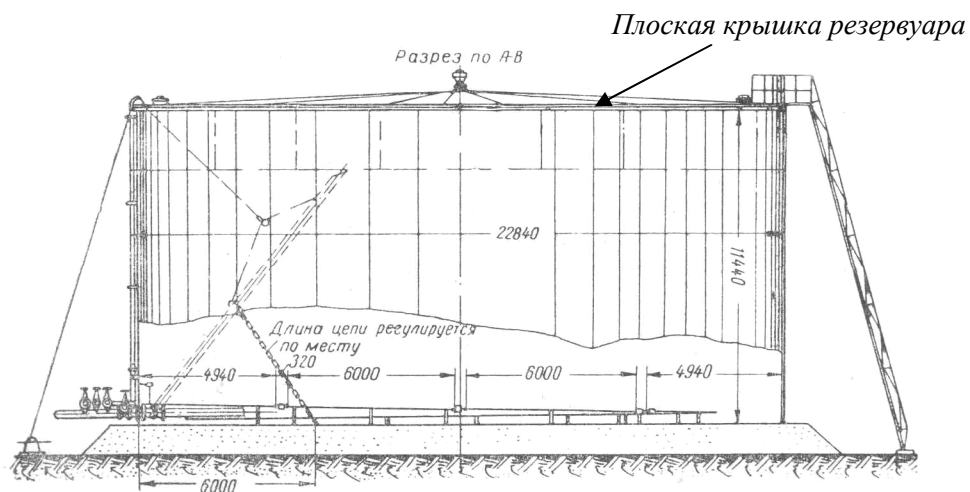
Конструкция вертикального стального резервуара для хранения жидкостей
